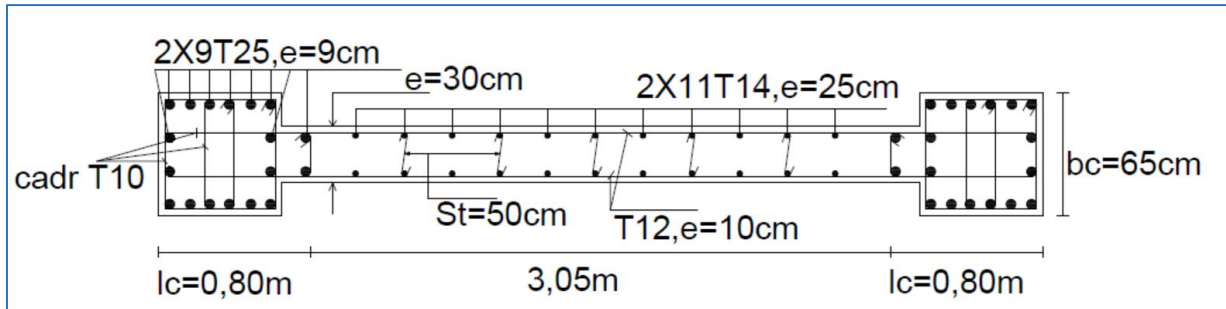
La coupe de ferrailage des voiles sens y épaisseur 30cm.
